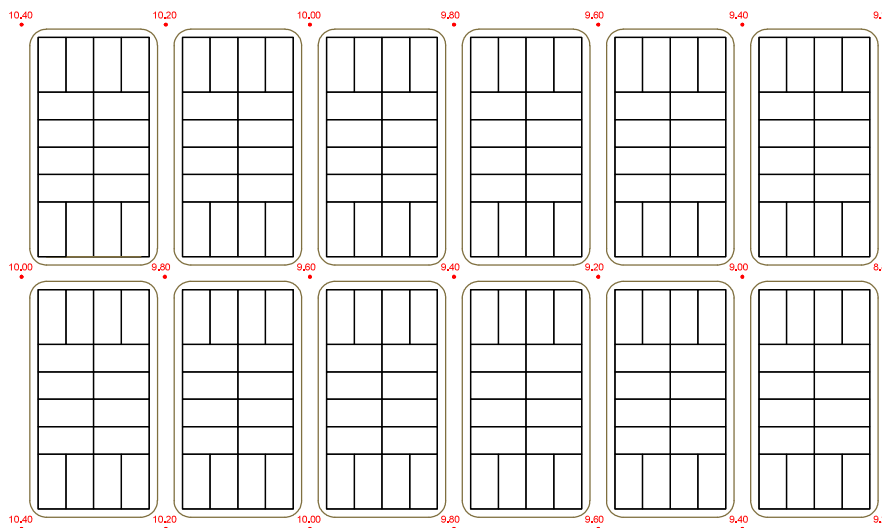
Planialtimetría del Barrio de Viviendas a Modelar
